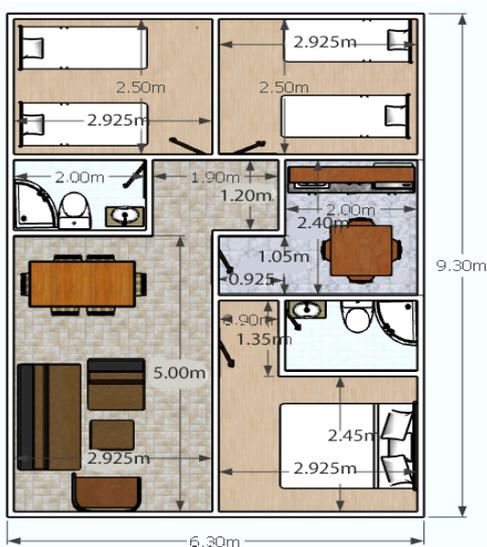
Vista de Planta de VUF 06 - AC: 58.59 m²
